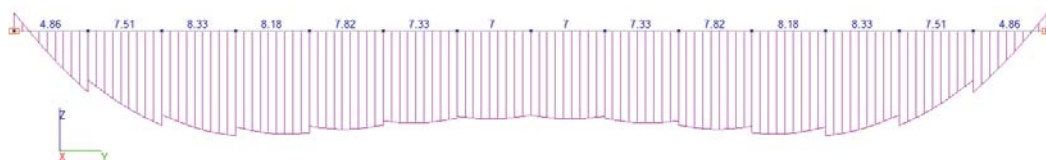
Эпюра изгибающих моментов M_y , Тм в центральной балке, расположенной вдоль оси Y модели SCAD перекрытия размером в плане ($L_x \times L_y$) 12,0 × 21,0 м с кессонами 1,5 × 1,5 м
